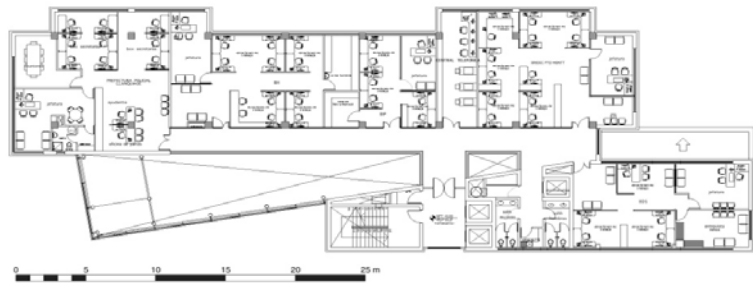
Planta Piso 3 – Oficinas – Nivel +6,80
